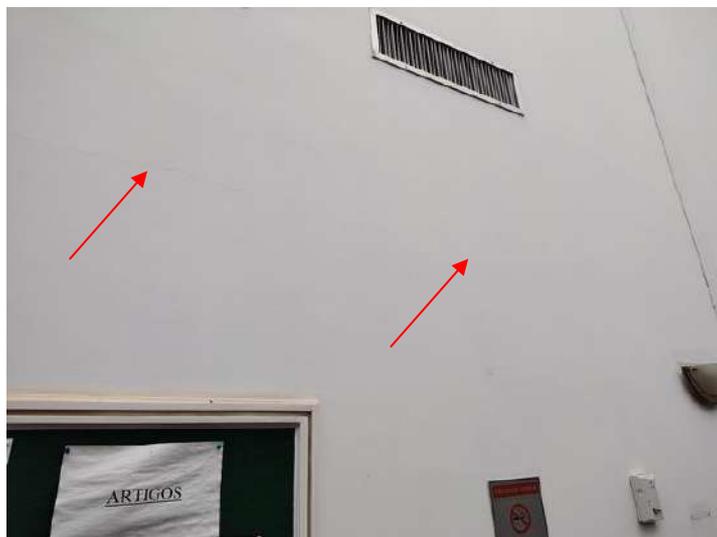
Hall Principal – Fissura horizontal na divisa com a Sala de Reunião
